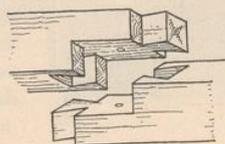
Das gerade Blatt mit schwalbenschwanzförmigem Zapfen, gegen seitliche Ausbiegung und gegen Zug in der Längsrichtung, aber nicht gegen Herausheben gesichert.
